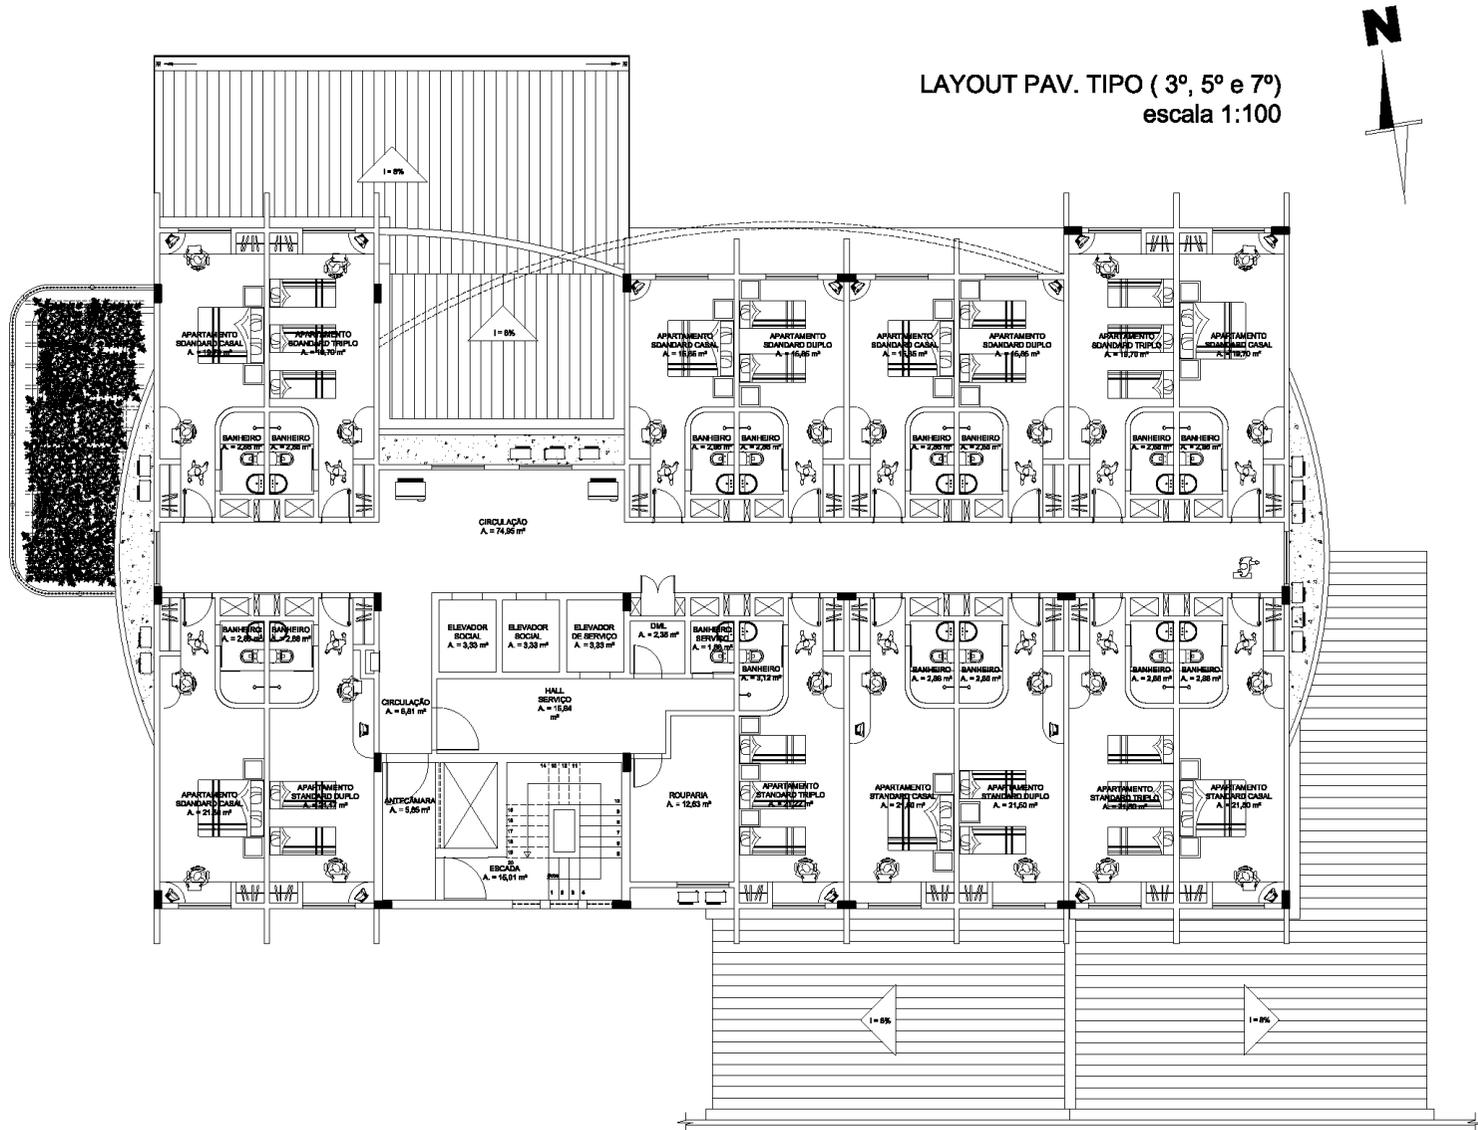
Layout Pavimento tipo andares 3, 5, 7
